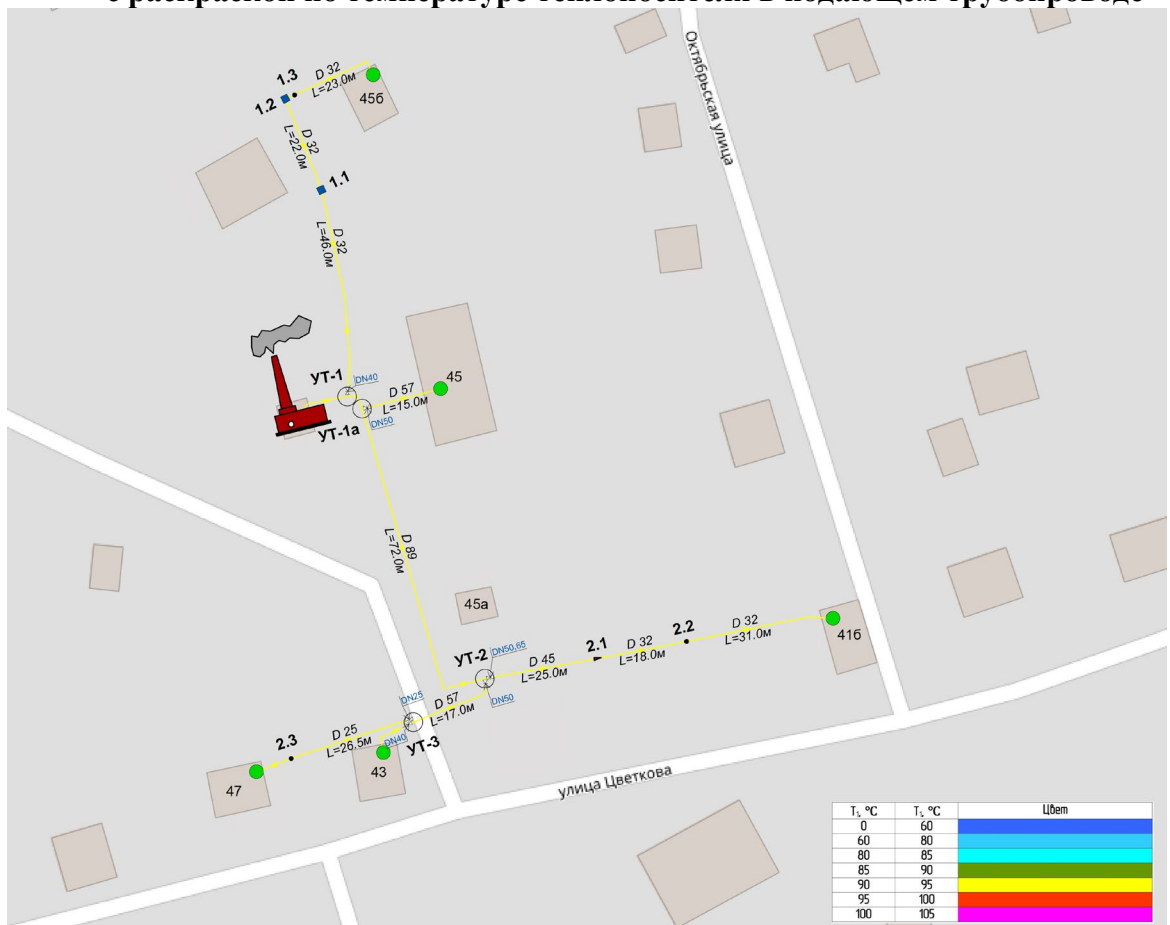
Схема тепловых сетей от котельной ул. Цветкова, 43а с раскраской по температуре теплоносителя в подающем трубопроводе
